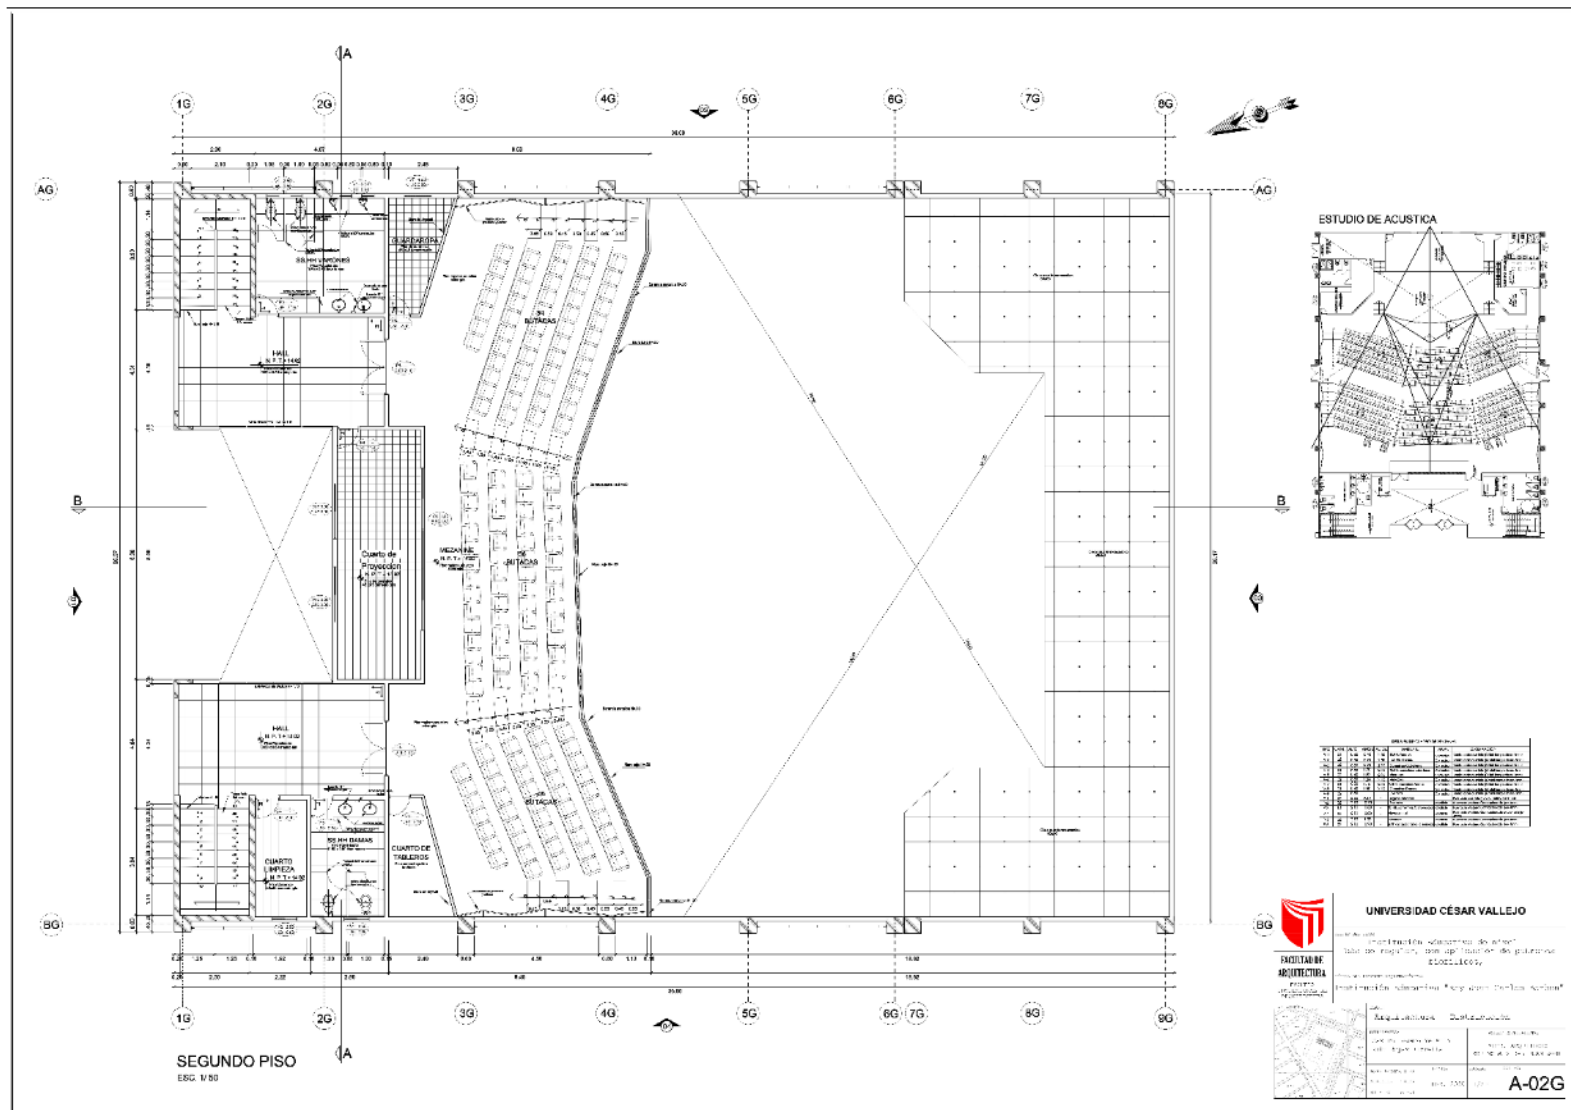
Plano segunda planta bloque "G", Fuente: elaboración propia
